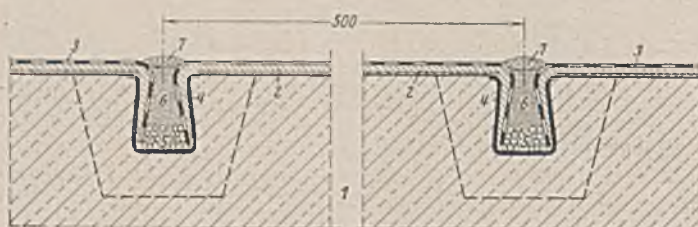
Geschweißte Naht einer Aluminiumdichtung, Bördelschweißung (Anwendung für ölfeste Metallauskleidung).
